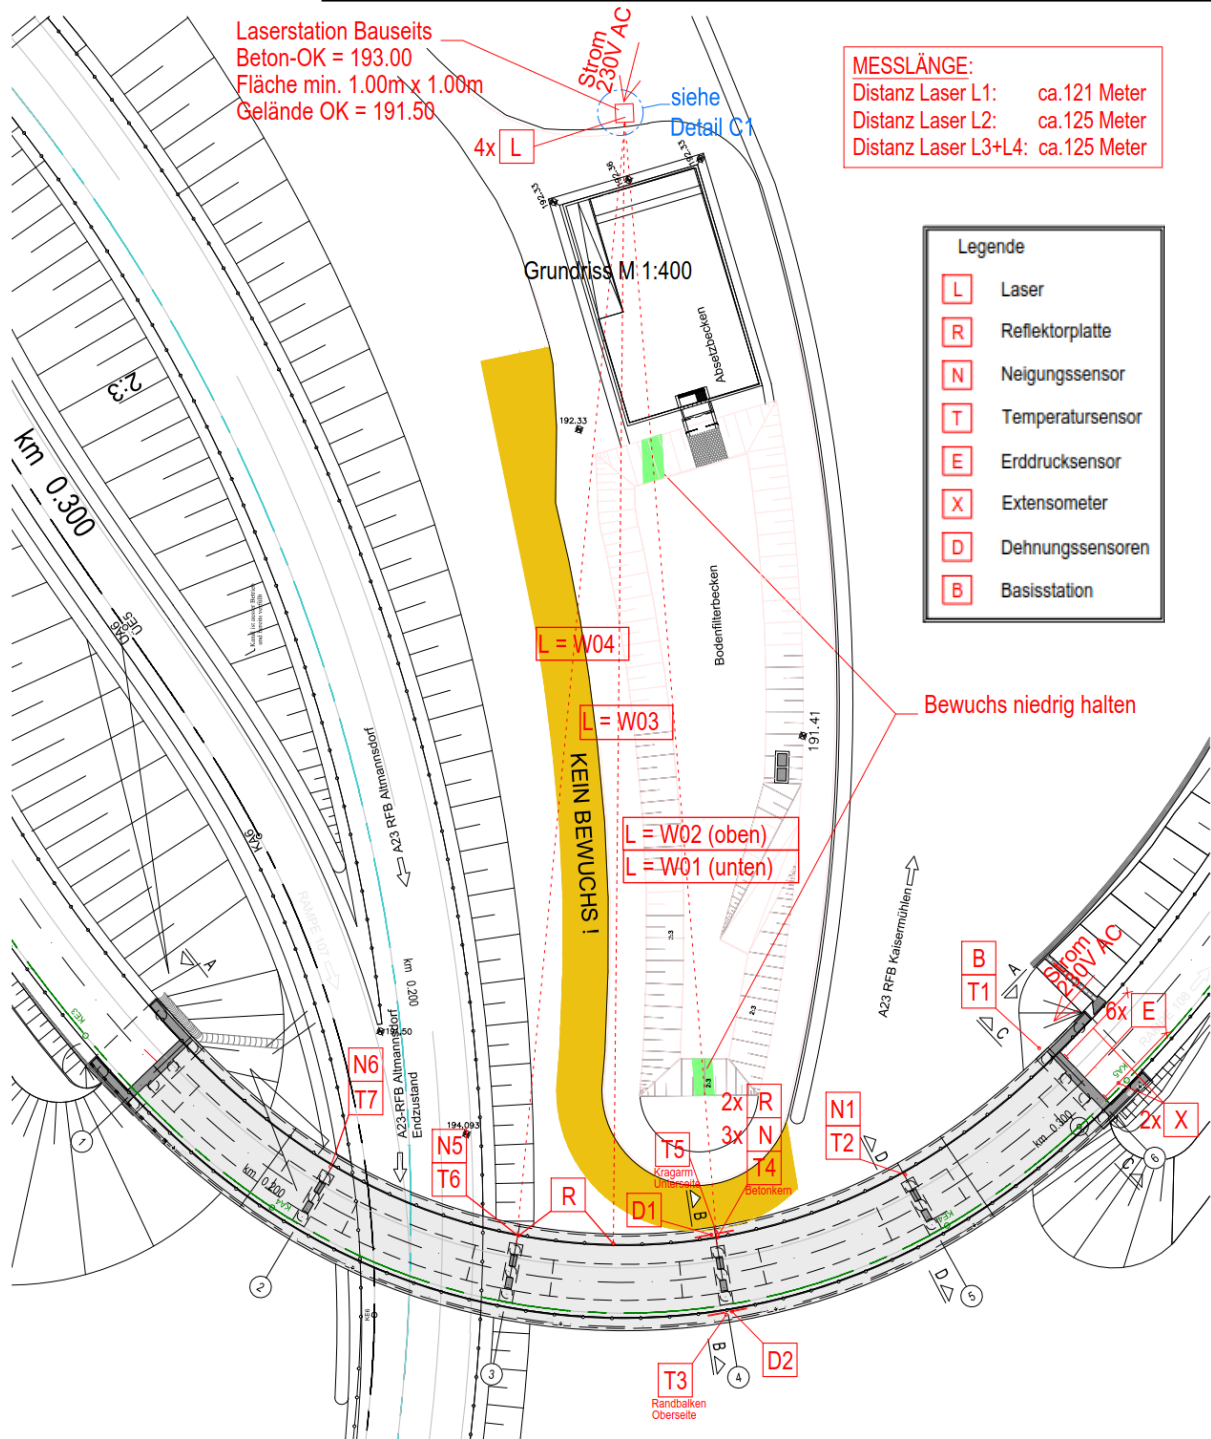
Anordnung der Sensoren am Tragwerk im Grundriss
